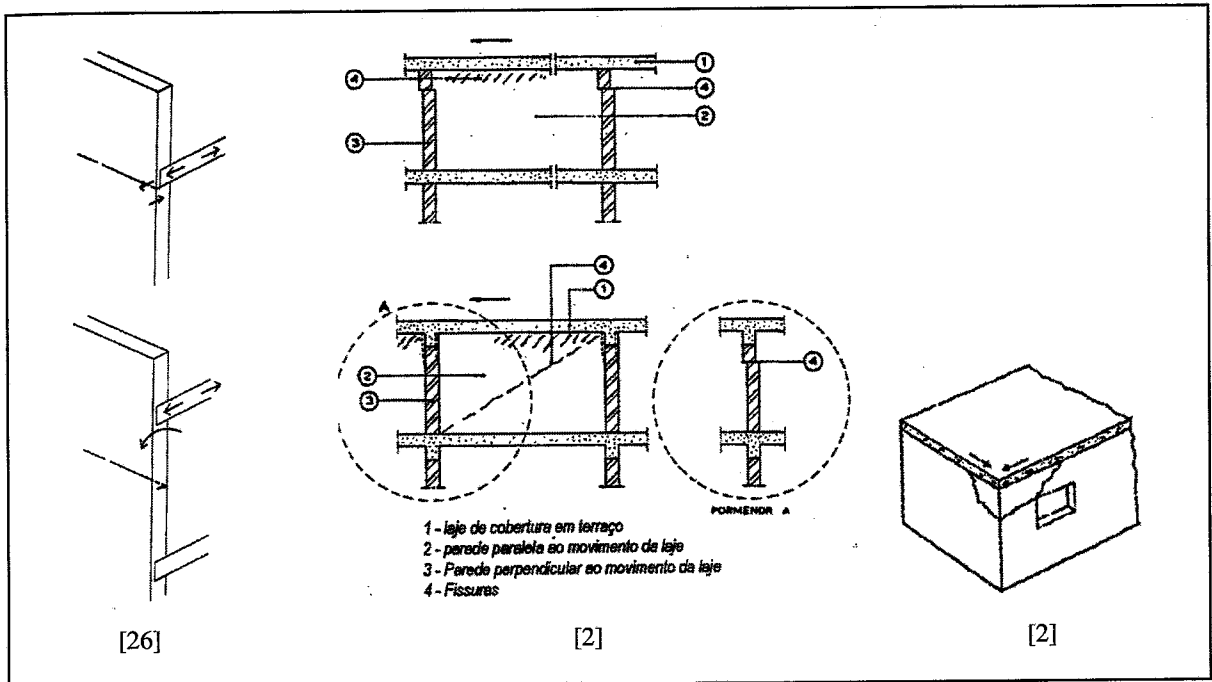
Fissuração típica devida aos movimentos da laje de cobertura
